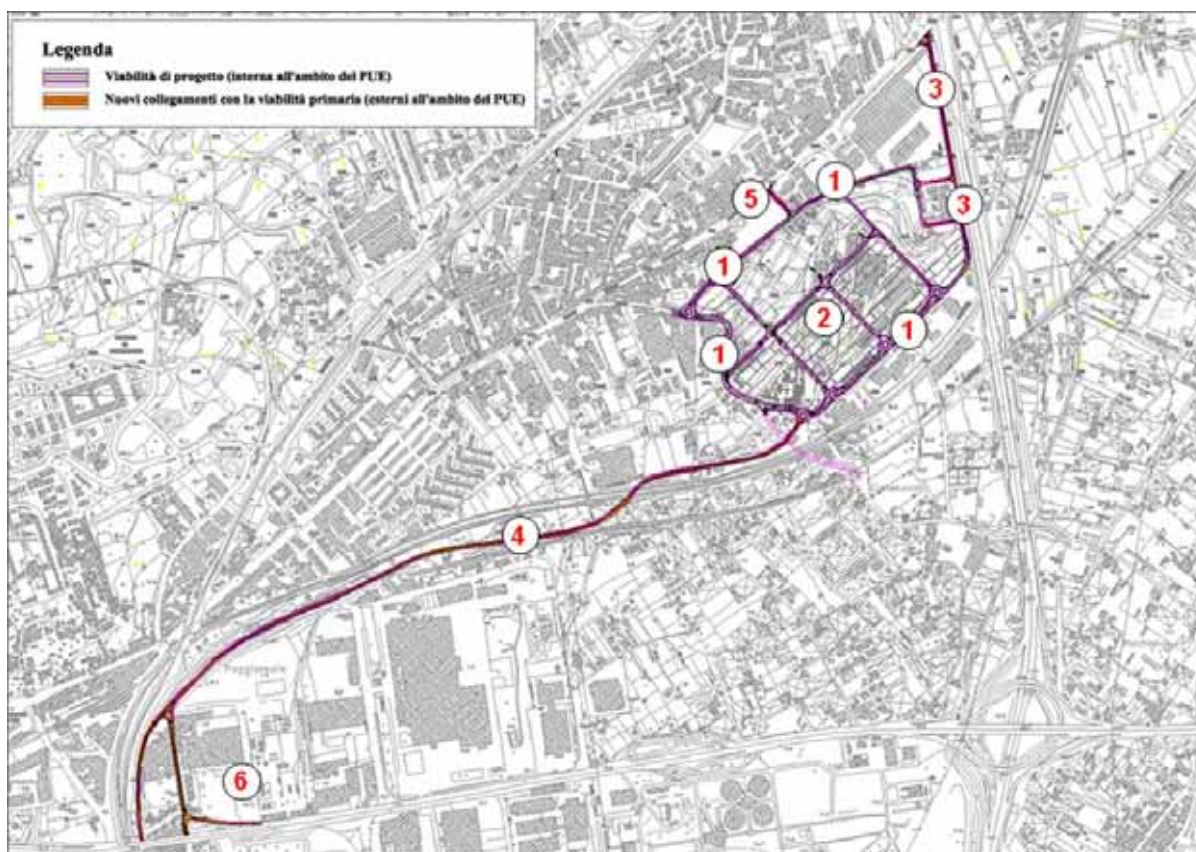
Gli interventi previsti sul sistema stradale dell'area
